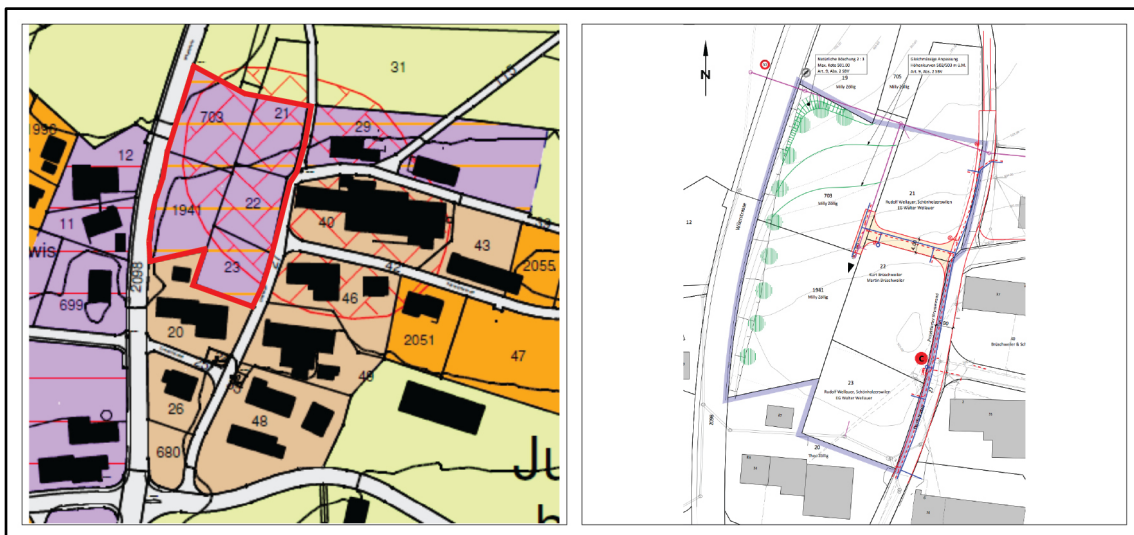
GP "Junkholz West", Zonenplan (links) und Gestaltungsplan (rechts) (BHAtteam Ingenieure AG, 2016c)
